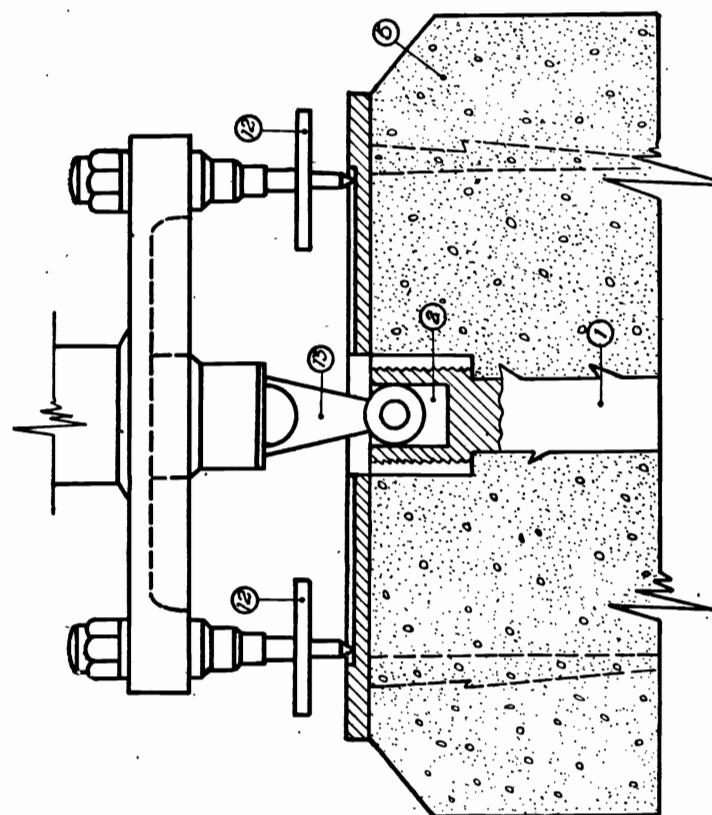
Schema de fixare a teodolitului pe o bornă din beton.
